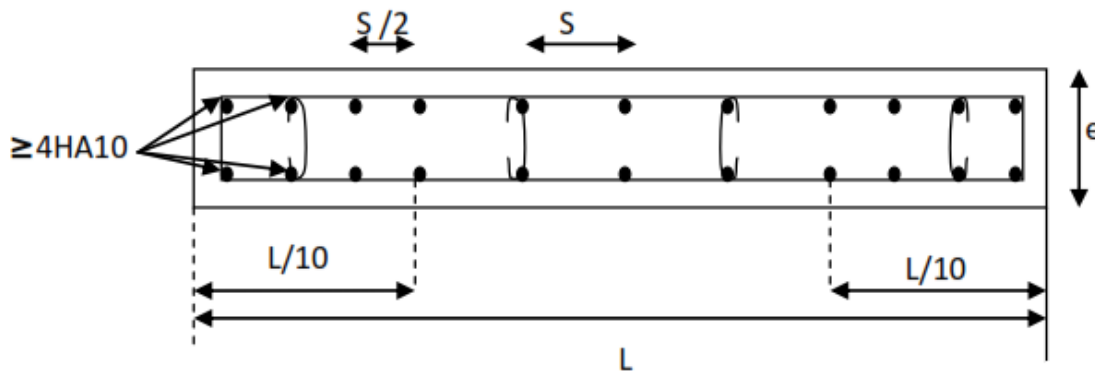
Disposition des armatures verticales dans les voiles.
